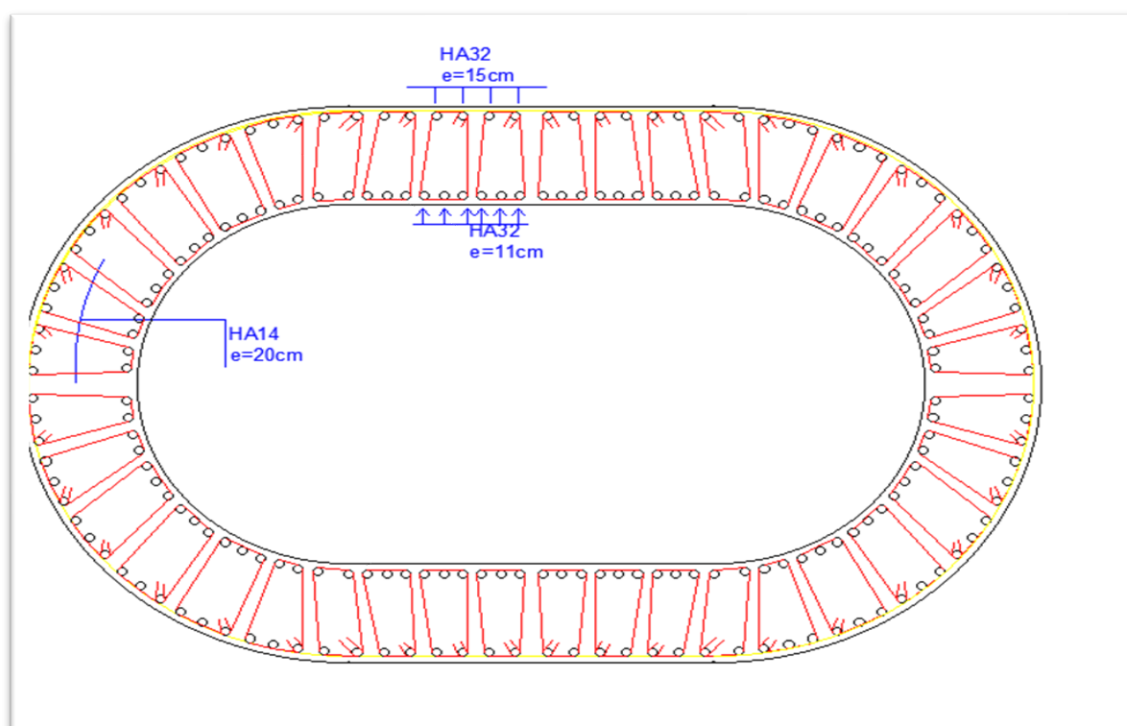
Schéma illustratif du ferrailage de la pile (vue en plan)
